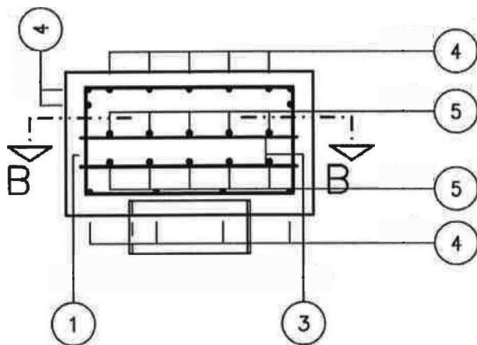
Bewehrungsanordnung Schnitt A-A für reine zentrische Vertikallasten [6]
